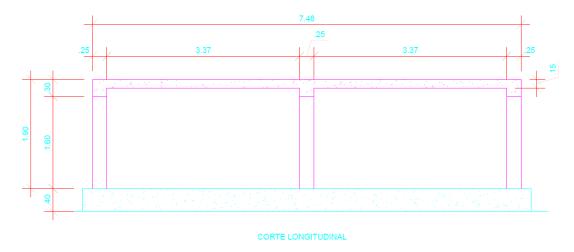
Croqui de corte longitudinal elaborado com as medidas coletadas (O autor, 2019)
